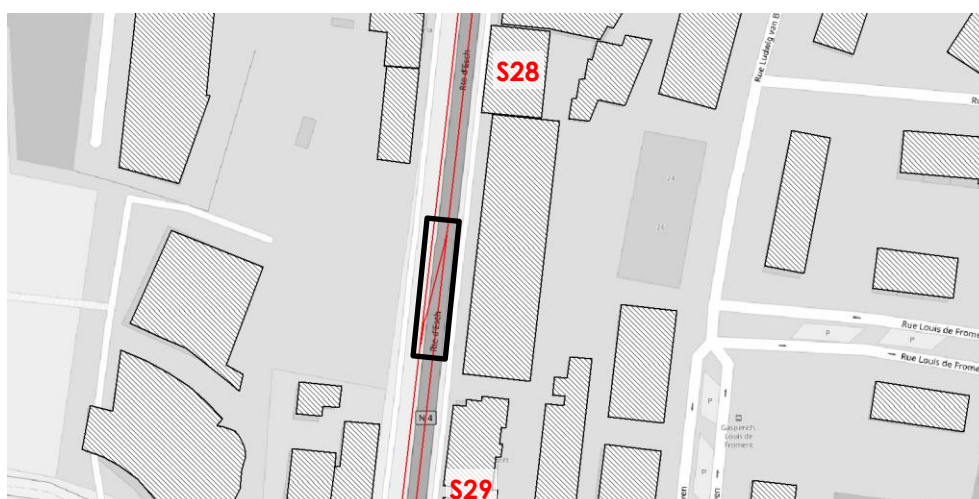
Secteur sud (REB) : appareil de voie au niveau de la station 4
